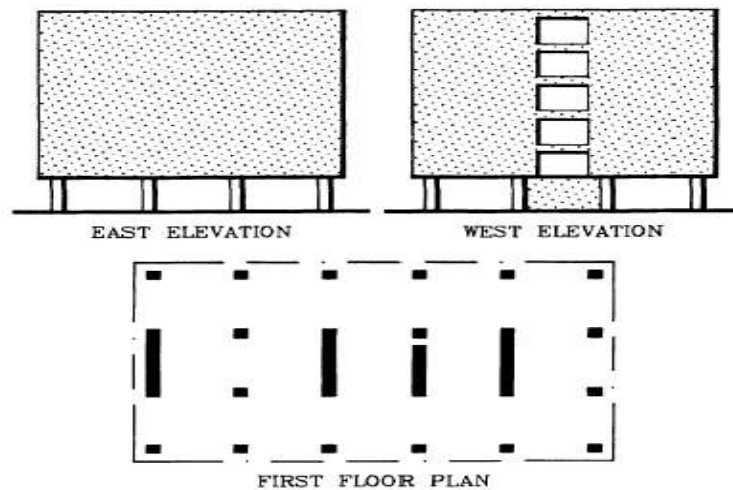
Vue en plan et élévation de la construction de Services Imperial Conty[66]
